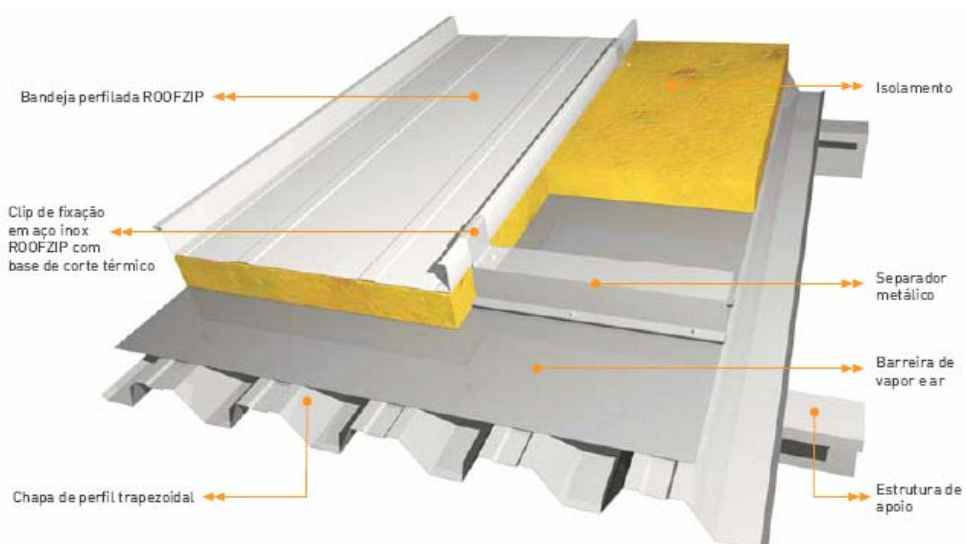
Pormenor da cobertura do tipo Roofzip. Imagem tridimensional.
